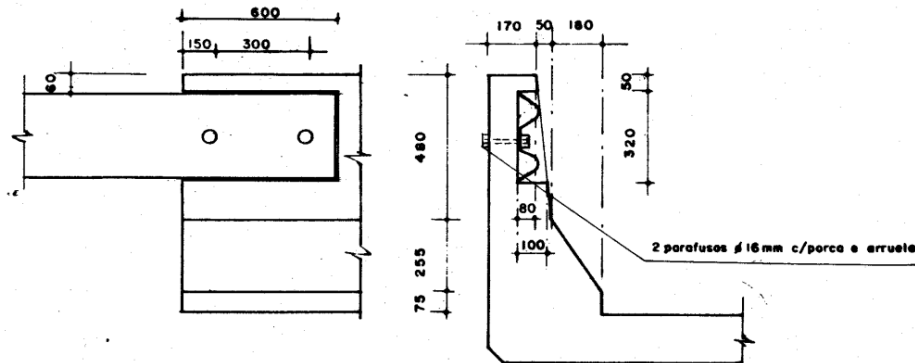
Ancoragem reta em rampa - Defesa metálica dupla.
